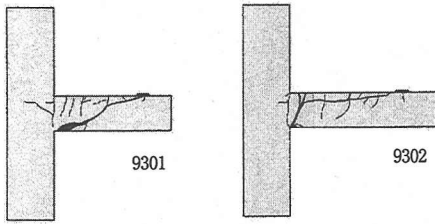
TYPE-I 試験体のひび割れ発生状況
